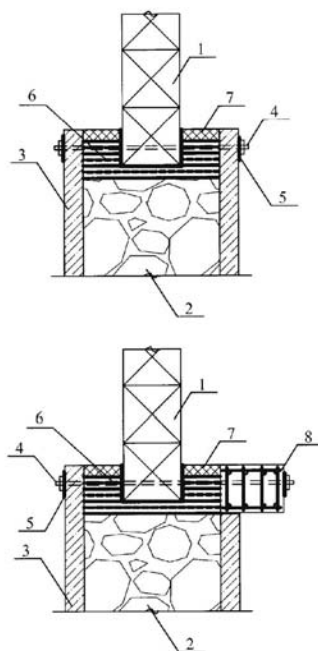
Вариант сейсмоизолирующего пояса в цокольной части здания (позиции: 1 — стены из бруса, 2 — фундамент, 3 — железобетонная рубашка, 4 — стяжной болт (гибкий), 5 — шайба по полимерной пленке, 6 — демпфер из амортизирующих материалов, 7 — цементный раствор или мин. вата, 8 — железобетонный пояс)
